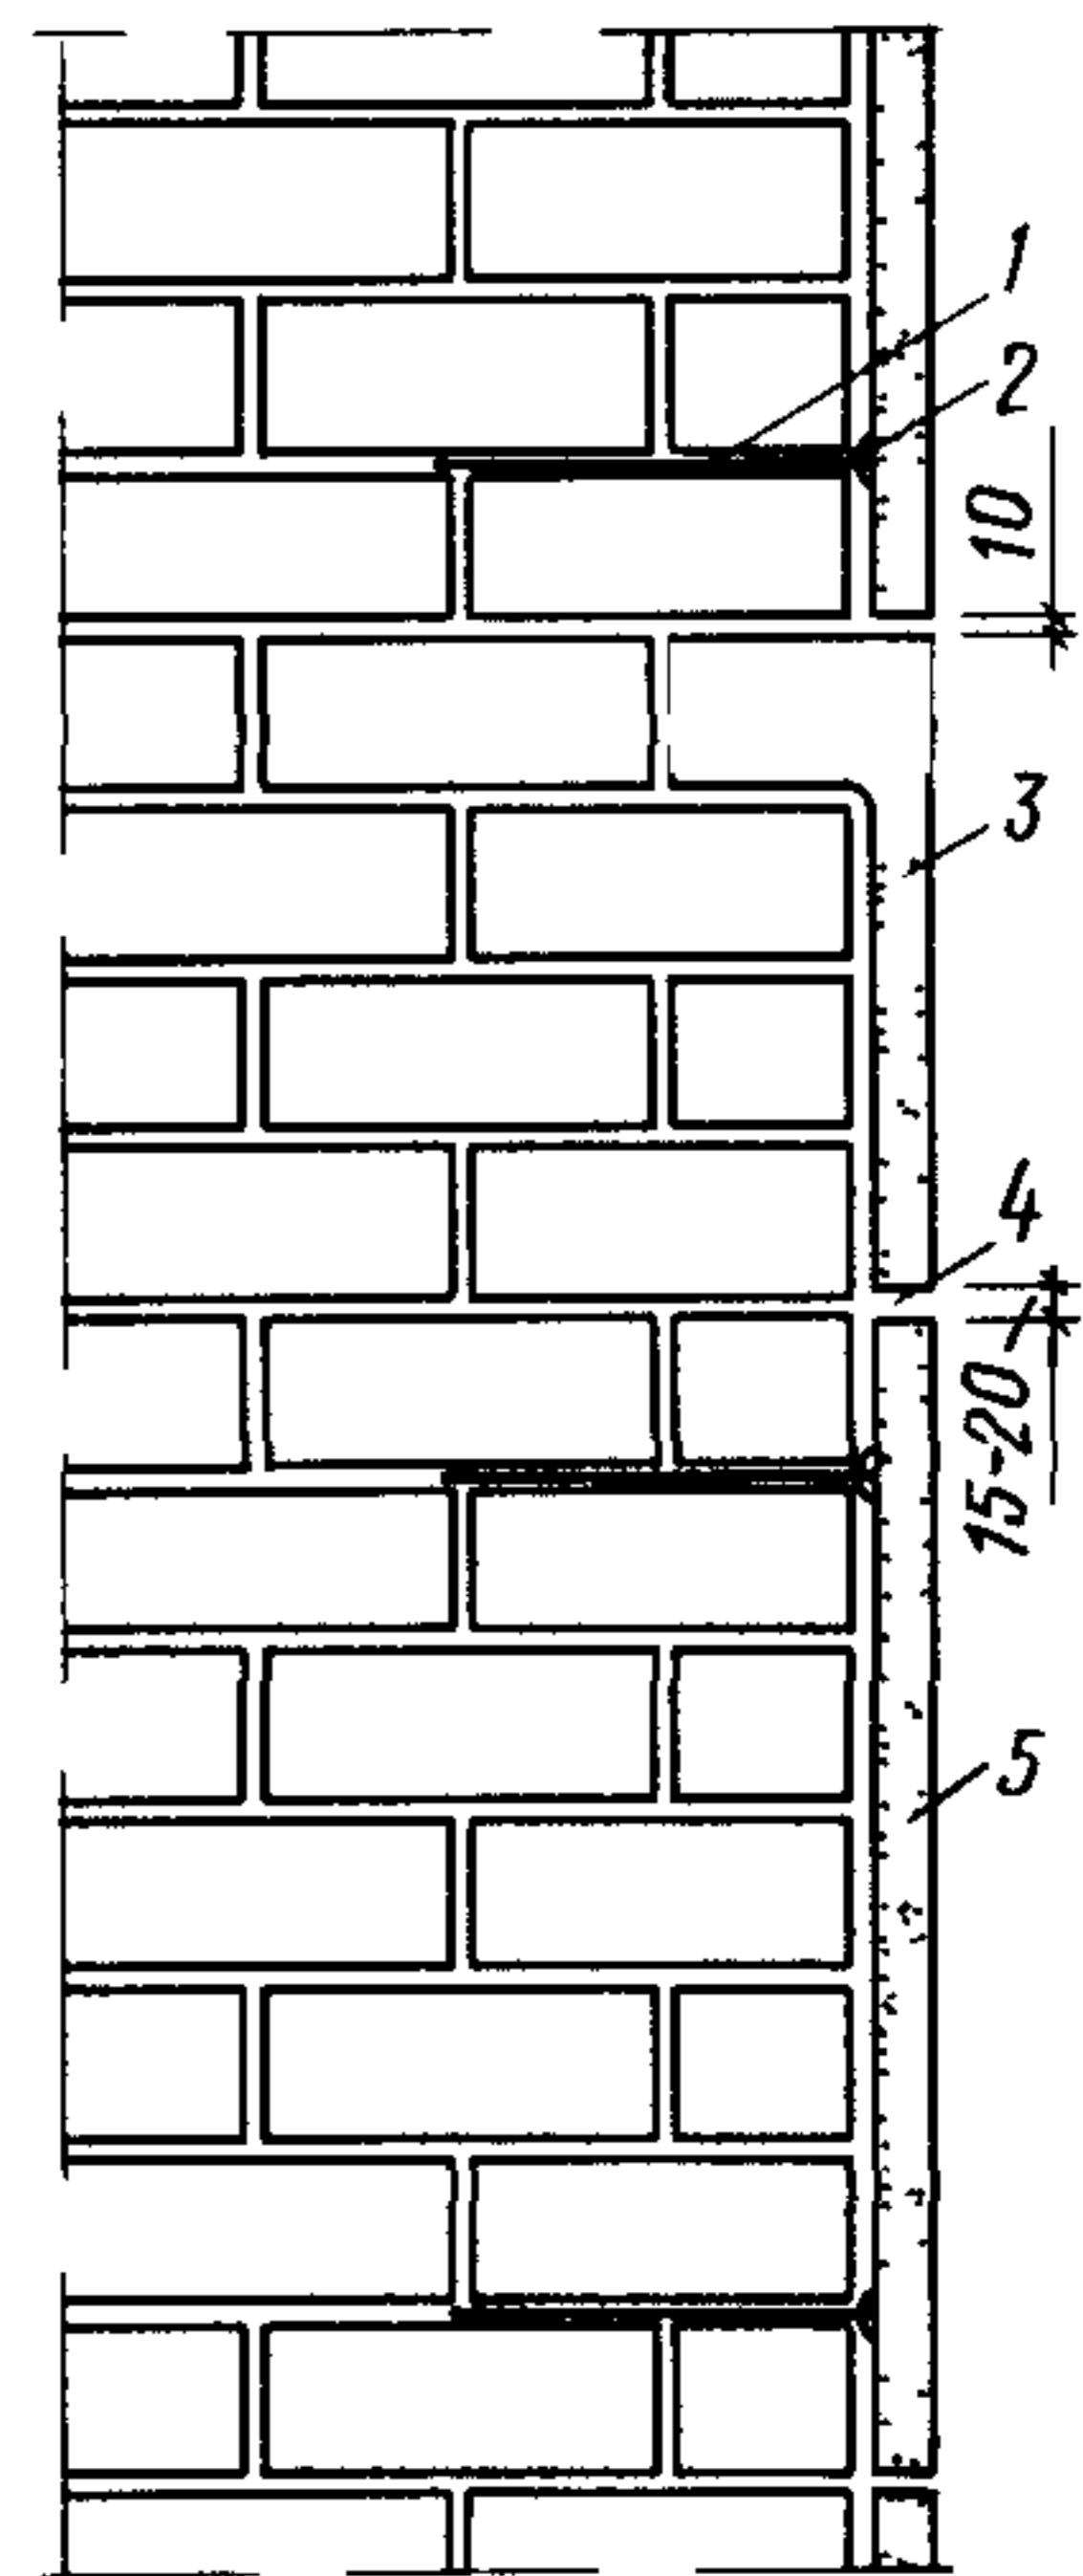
Кладка из кирпича или камней с облицовкой фасадными бетонными плитами
